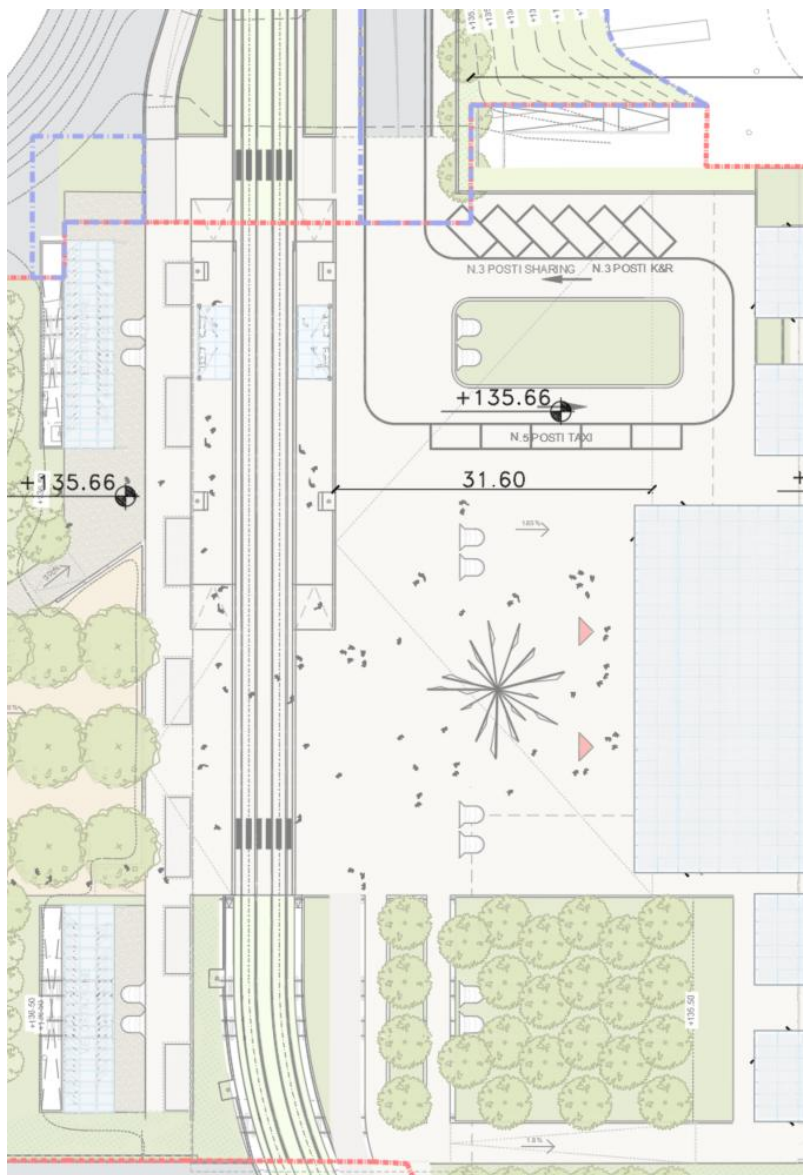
Estratto planimetria piano ingressi – piazzale nord
